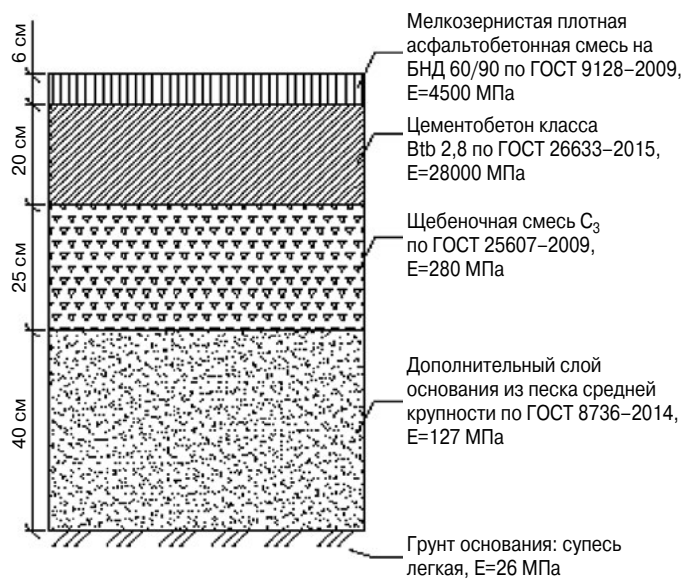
Конструкция жесткой дорожной одежды без армирования
